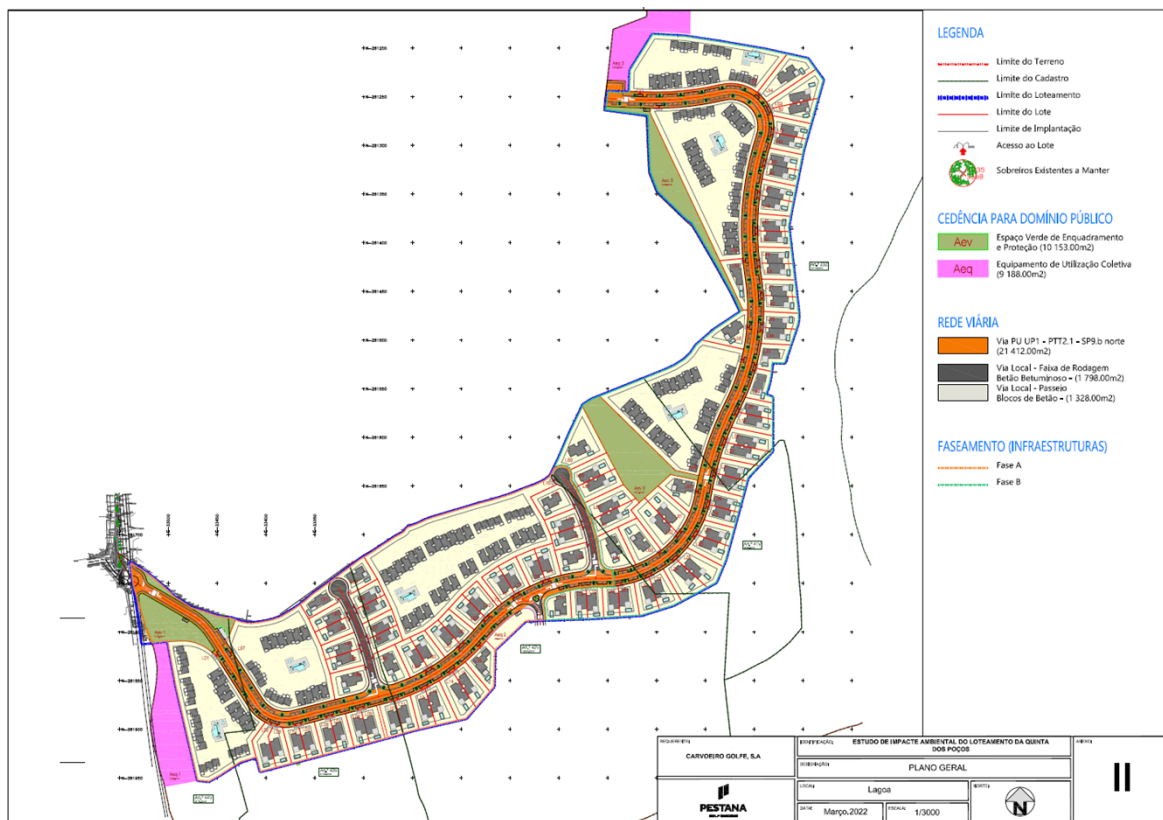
Plano Geral (fonte: peça desenhada extraída dos elementos do EIA).
